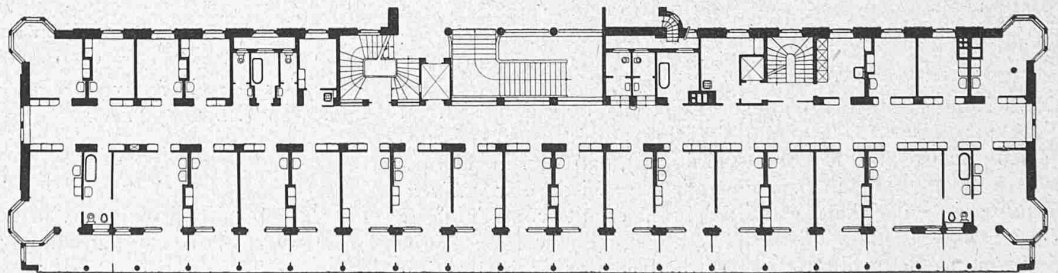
Grundriss vom I. Obergeschoss des Sanatoriums Altein. — Masstab 1:450.
